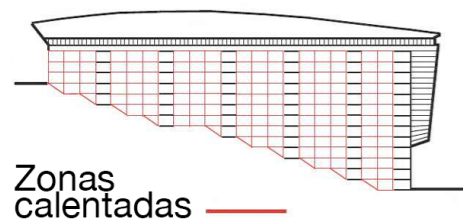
| Zonas calentadas fachada EMPAC. Fuente: Charles Linn.
